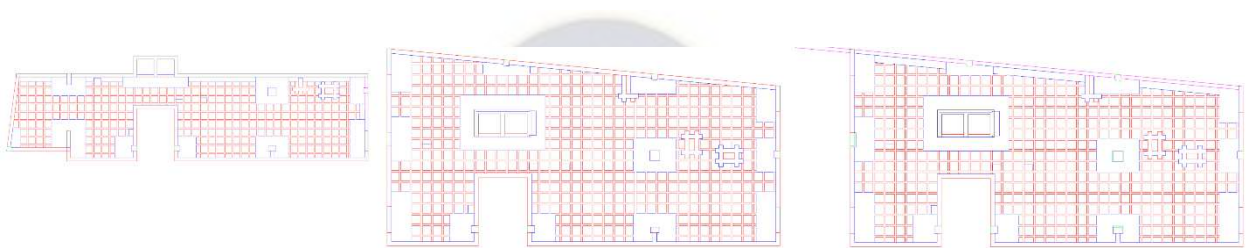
Archivos DWG Losas estructurales tipos - Fuente: Elaboración propia
